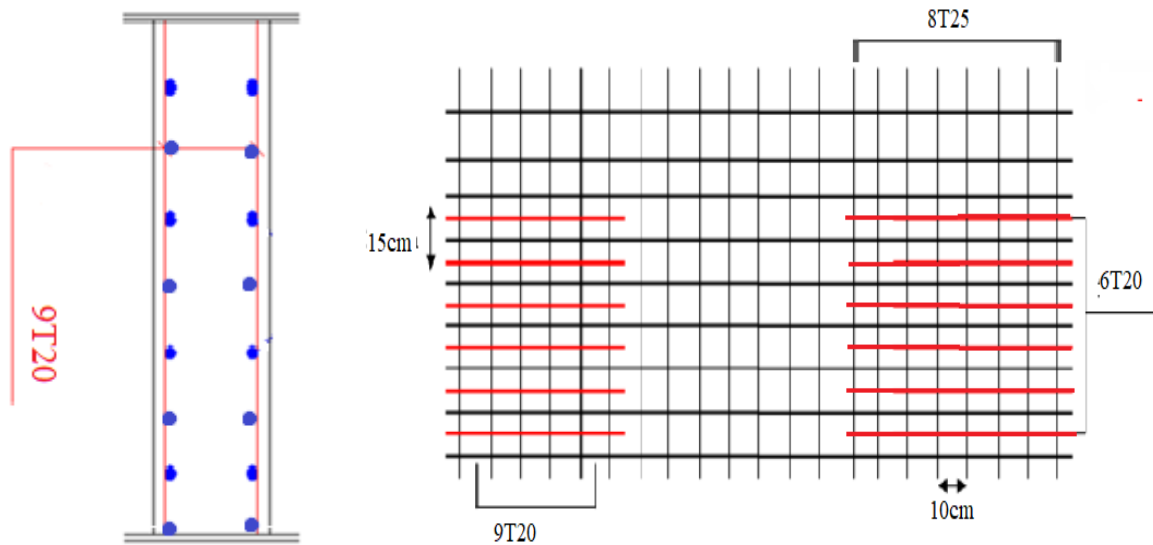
Schéma de ferrailage du mur de soutènement
